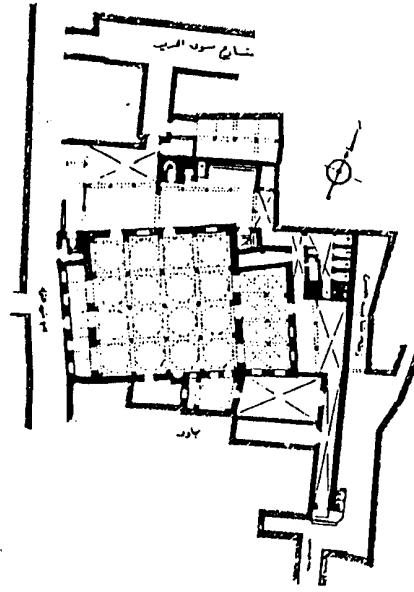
مسقط أفقي لمشهد السبع وسبعين ولي بأسوان جنوب مصر
